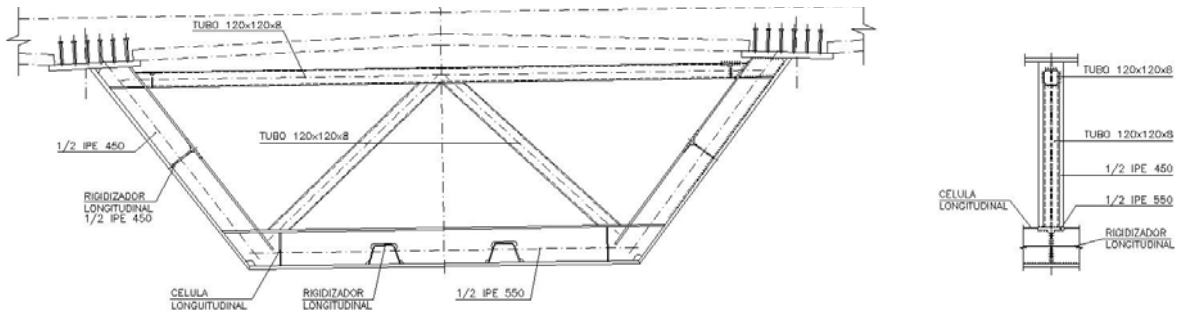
Diafragma tipo; a) Alzado; b) Sección
